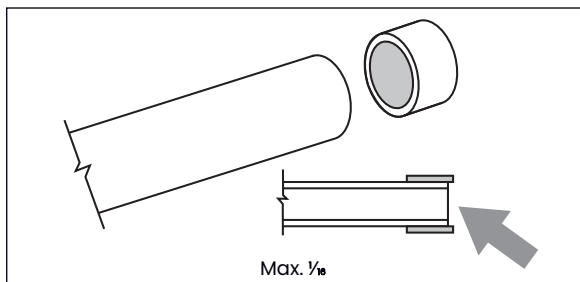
Glisser la bague dilatée sur l'extrémité du tuyau
